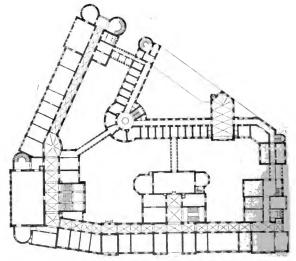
Gerichtsgebäude, Grundrifs des II. Stockwerks.
